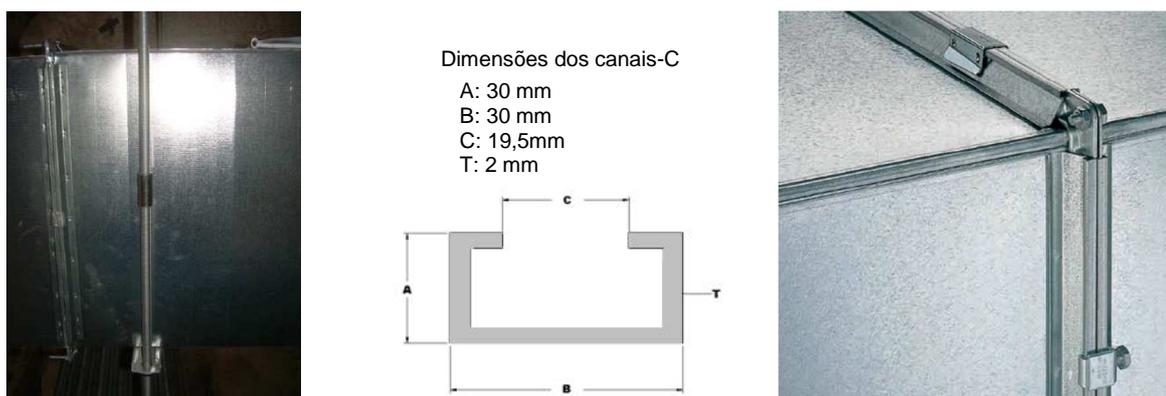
Sistema de suspensão de condutas e junta transversal do Sistema METU.
